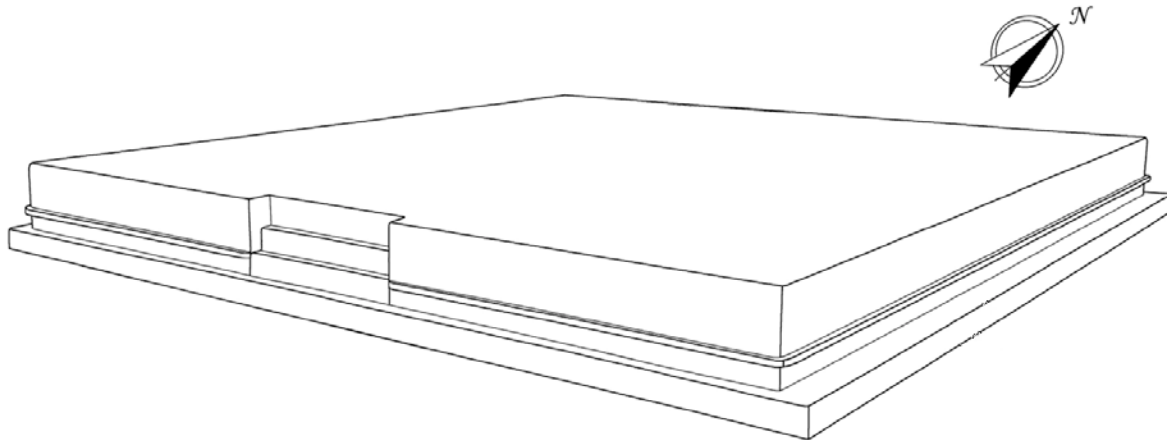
Fachada sur de Sub-2, Estructura 12H3, Grupo B. Bloques de piedras calizas talladas, con detalles de moldura en la parte media del muro. (Dibujo: D. Del Cid, 2014)
